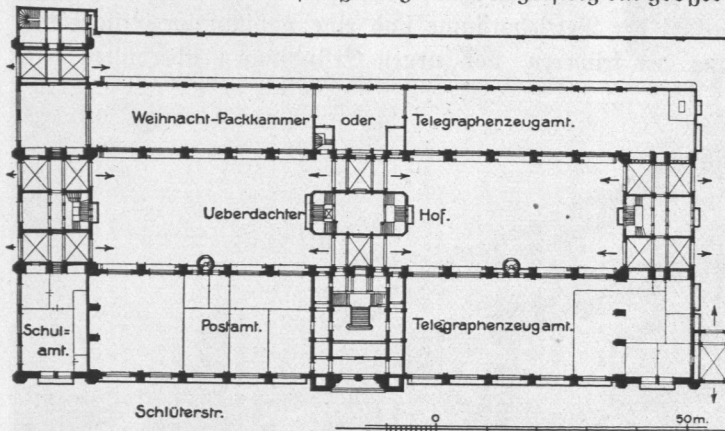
Fernsprechgebäude, Erdgeschoß, Grundriß.
